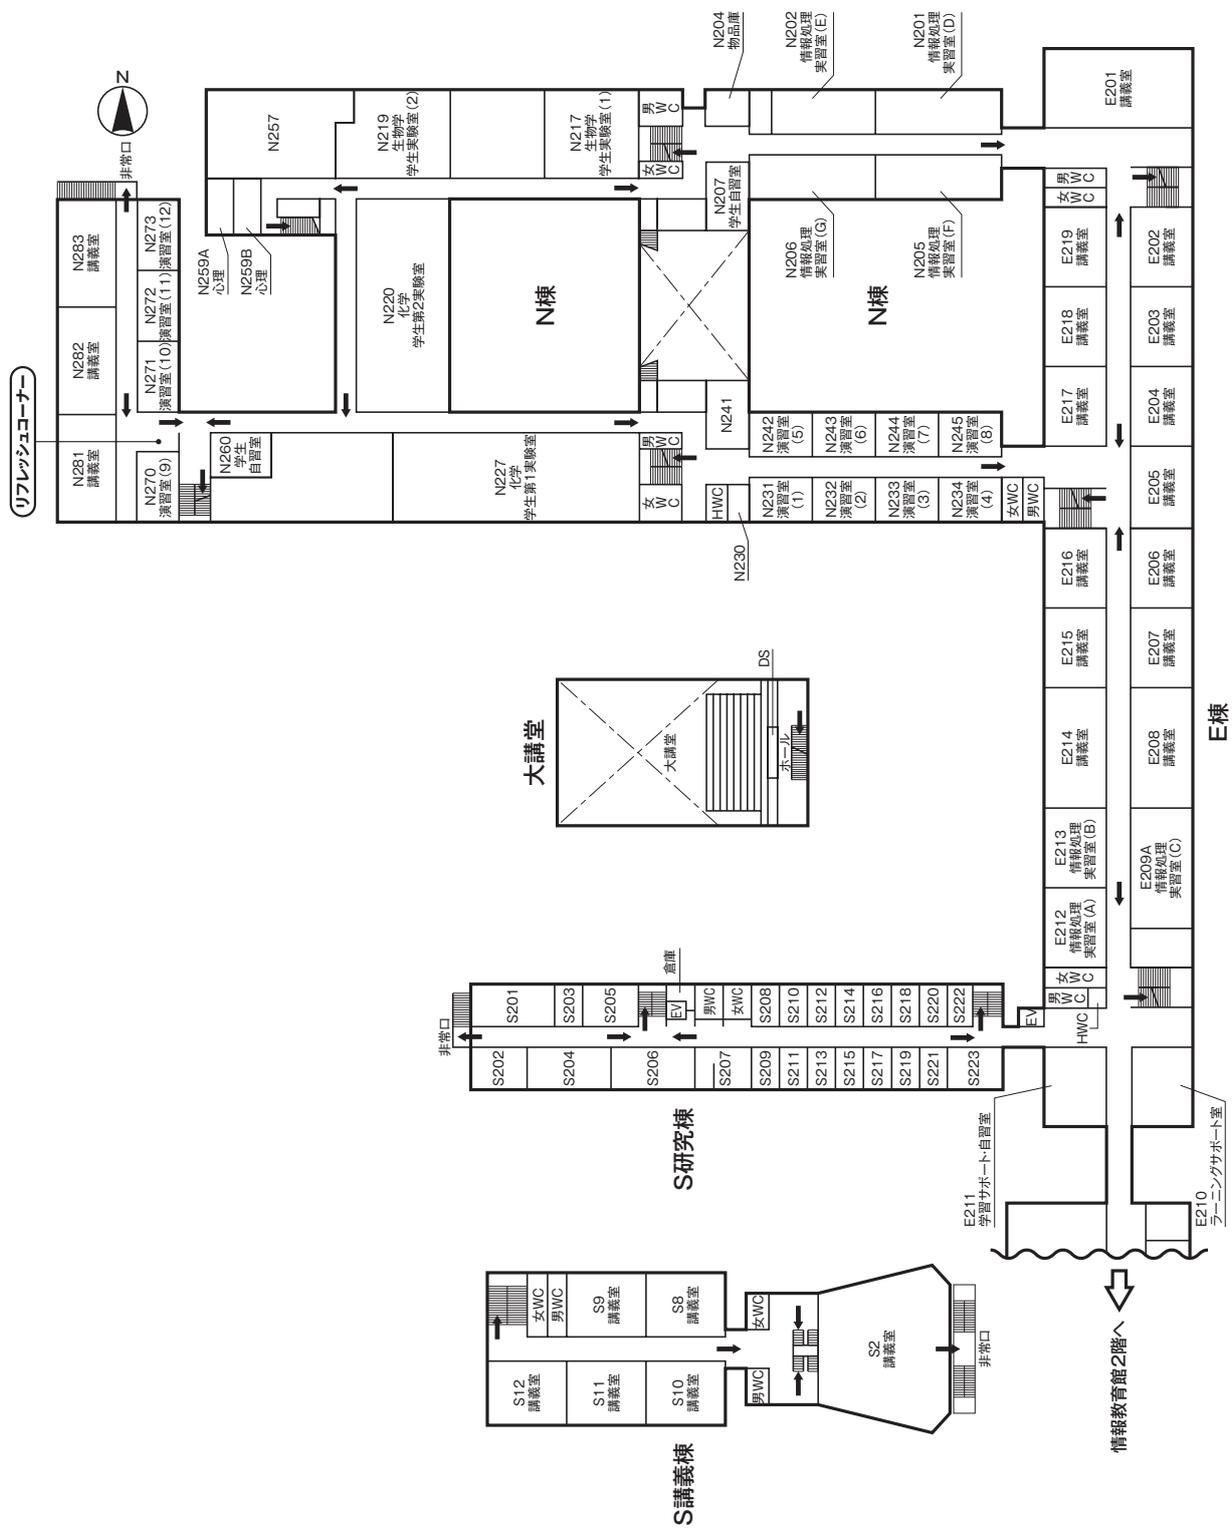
高等教育推進機構 2階 / 平面図及び避難経路図
